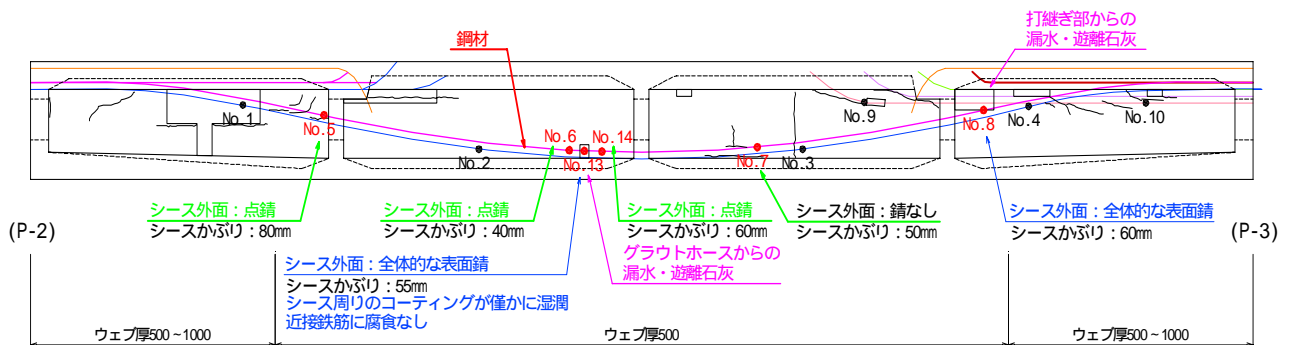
箱桁内部のひび割れ・遊離石灰等の状況と削孔目視調査箇所(第3径間:P2~P3)
